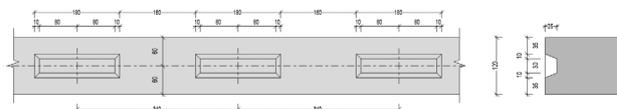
Junta indentada na interface lateral entre painéis de laje CREE
